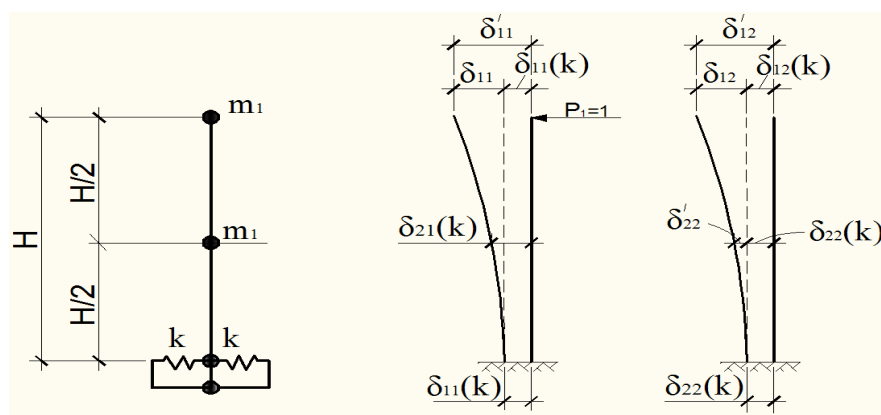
Схема определения единичных перемещений для опоры с сейсмоизолирующим фундаментом
